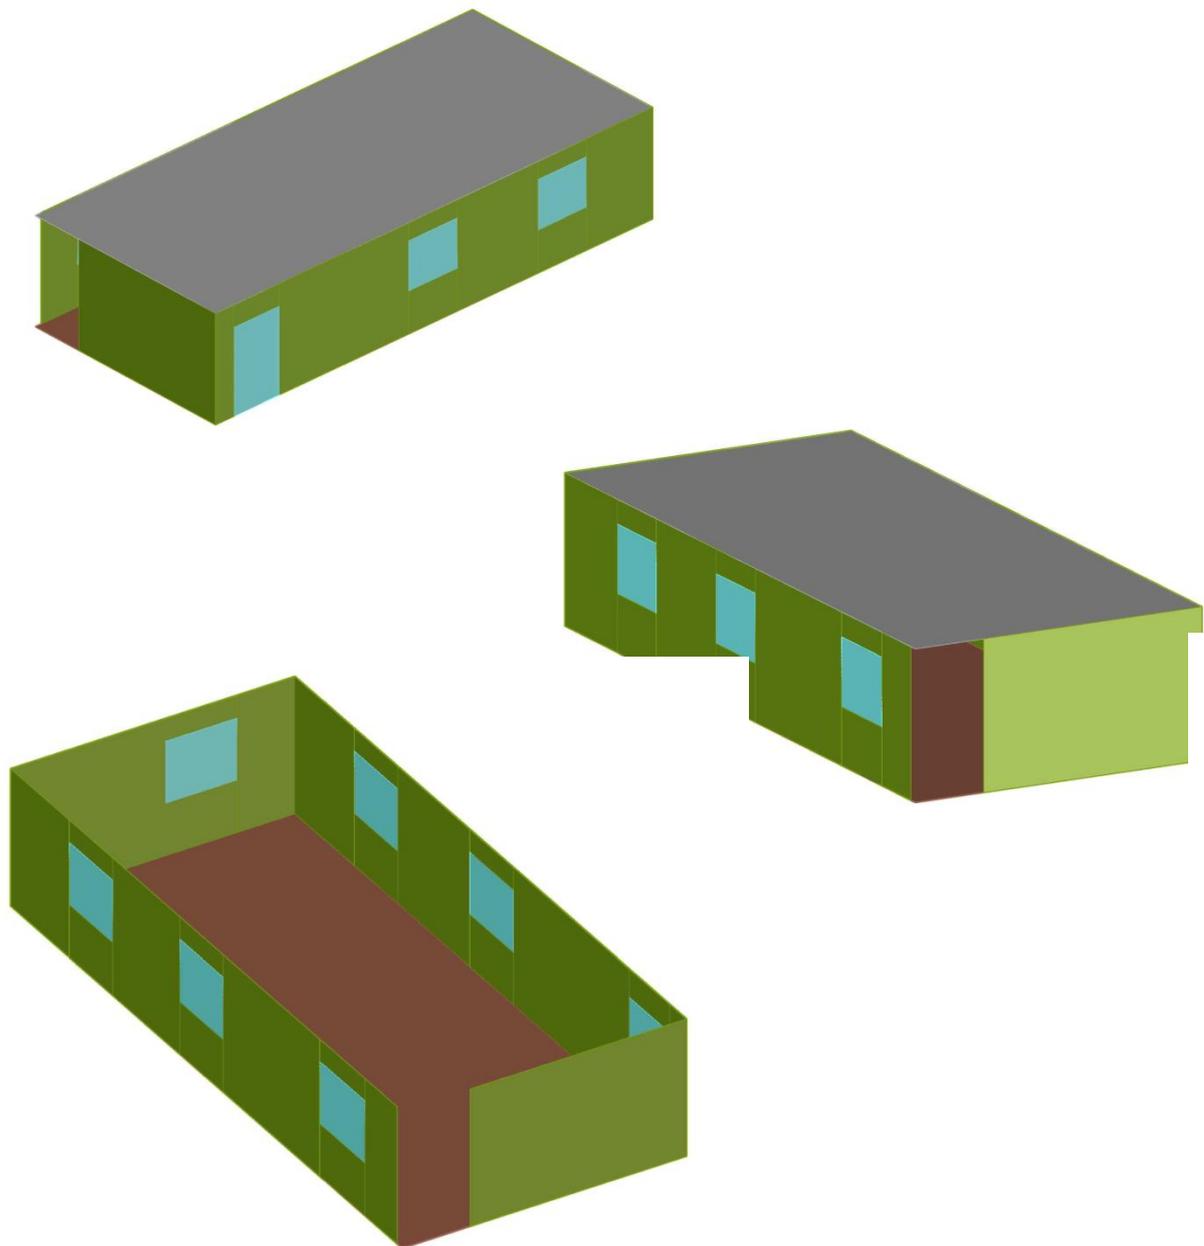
Vistas de la sala de ensayo con 3D Cara.
